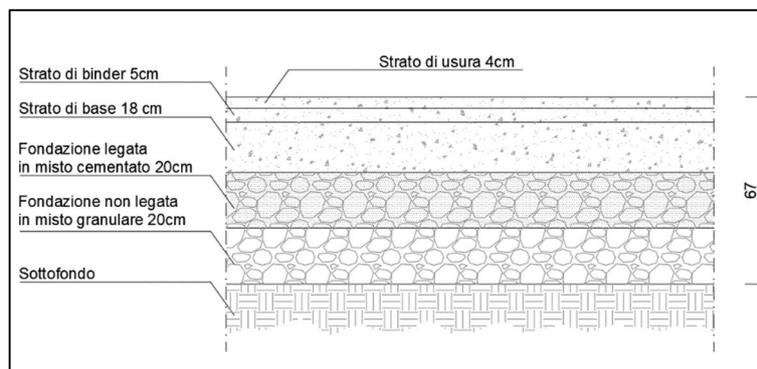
Sezione tipo pavimentazione su nuovo sedime e rotonda (tipo P1A)
